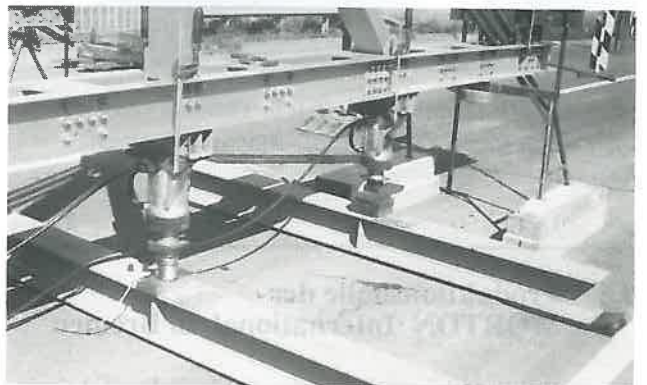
Verteilung der hydraulisch erzeugten Testlast auf 6 Radaufstandsflächen durch Quertraversen
